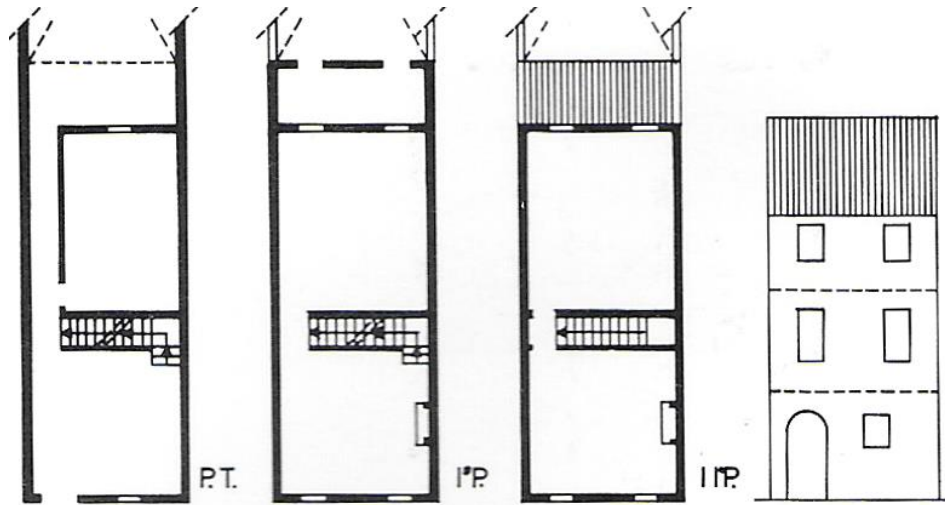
Plantas y alzado casa adosada a vestíbulo.
